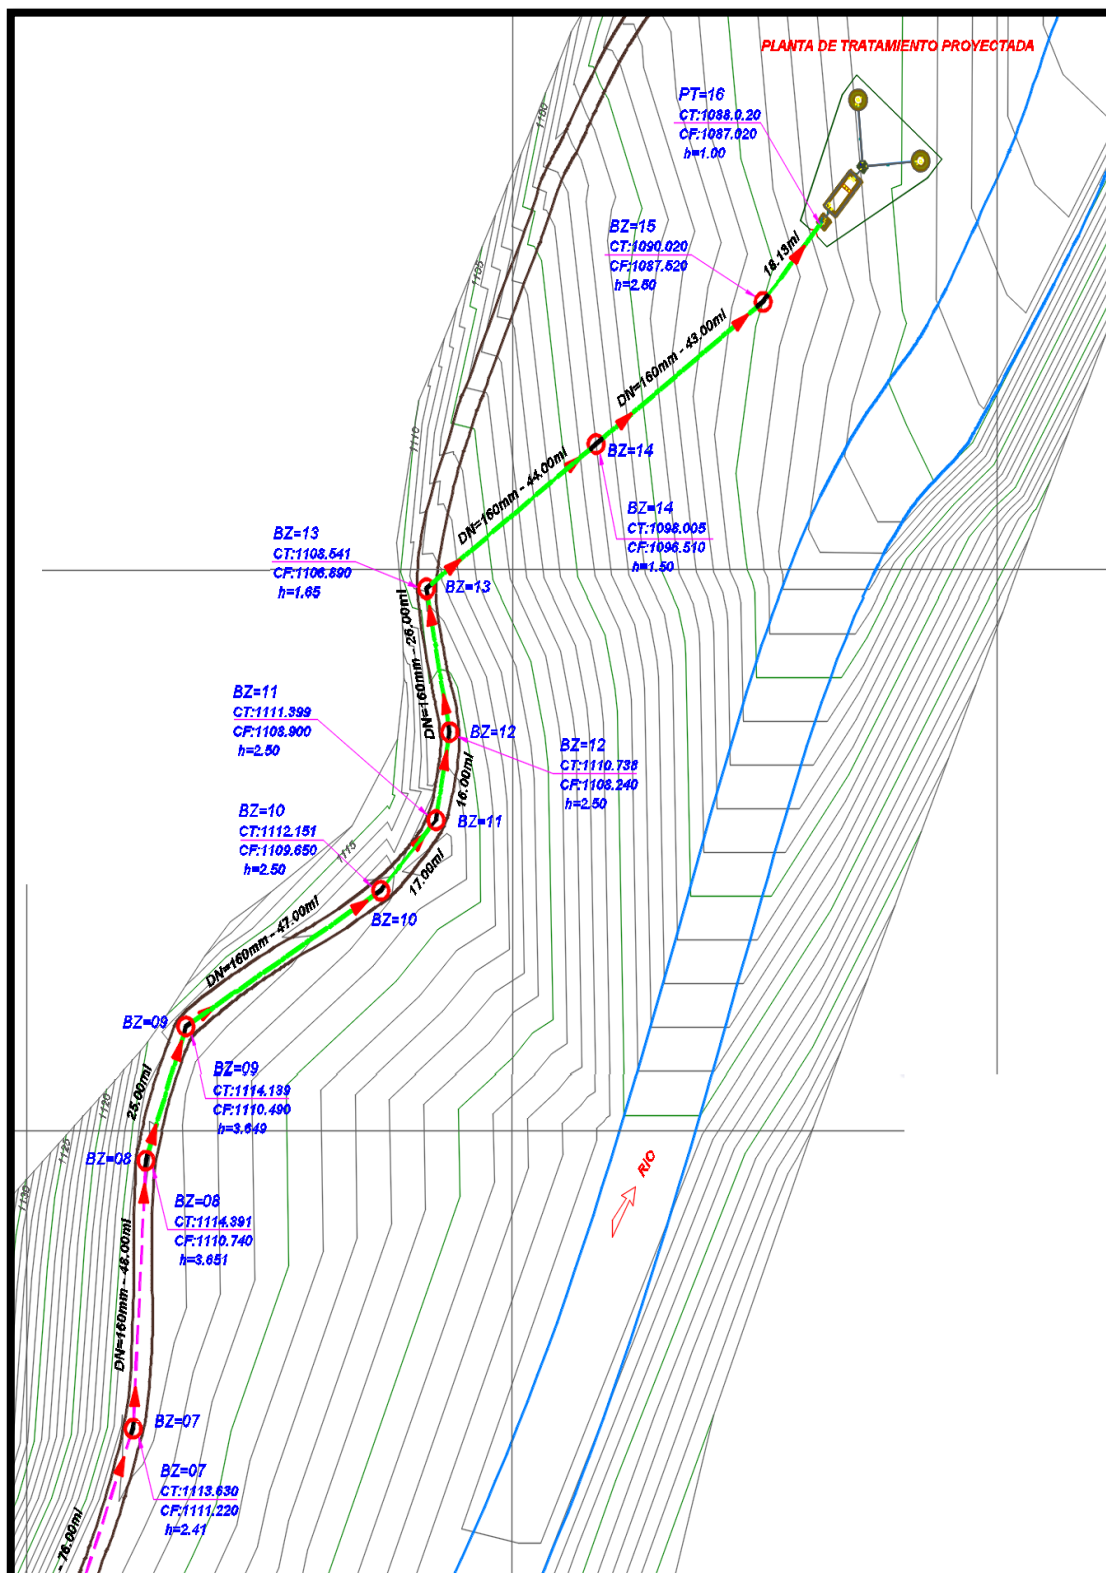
Diseño de Planta de Red de Alcantarillado Parte 2
